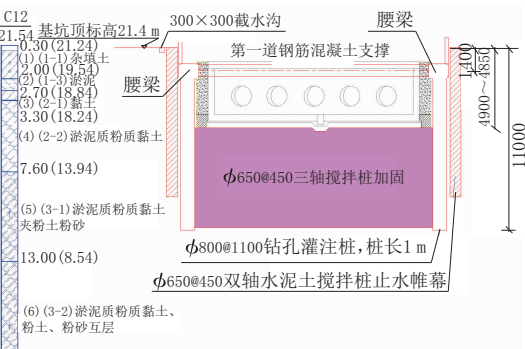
YA1 结合井基坑围护结构剖面图(单位:mm)
